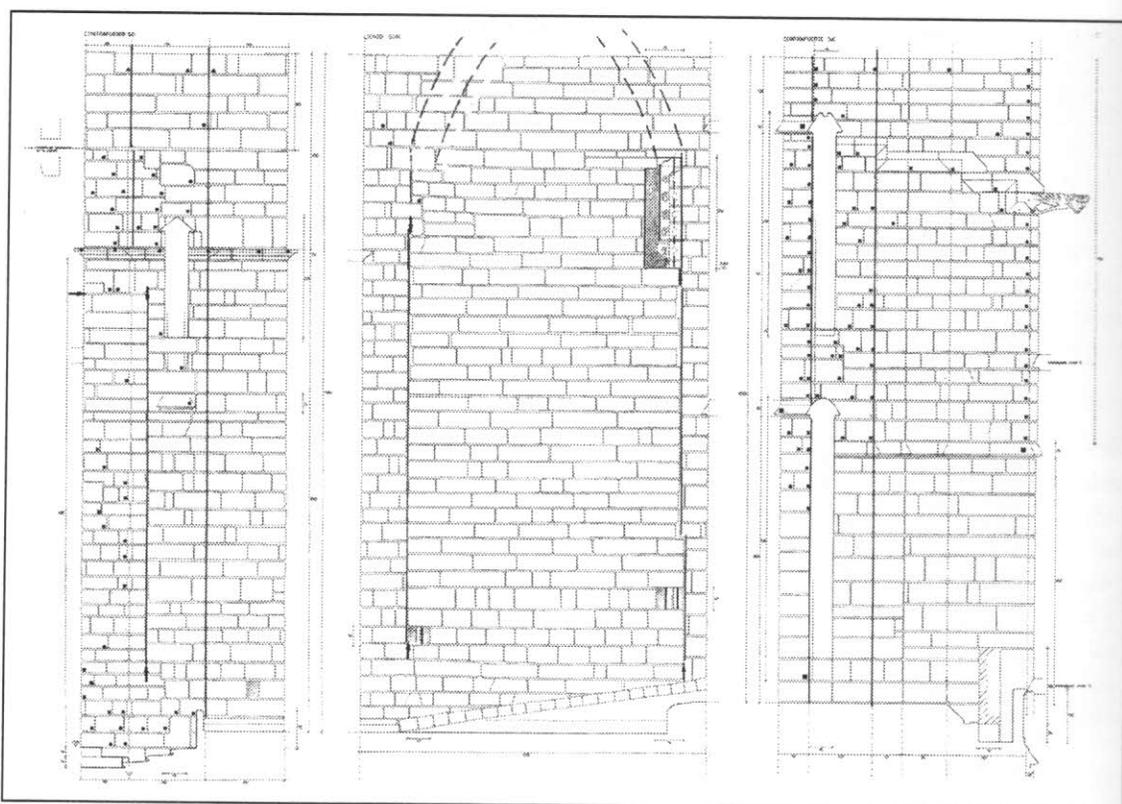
Desarrollo del cuerpo medio de la torre norte, cara sur: contrafuertes y muro de cierre con la fase de arrepenimientos. Dibujo de M^a Ángeles Murciego.
